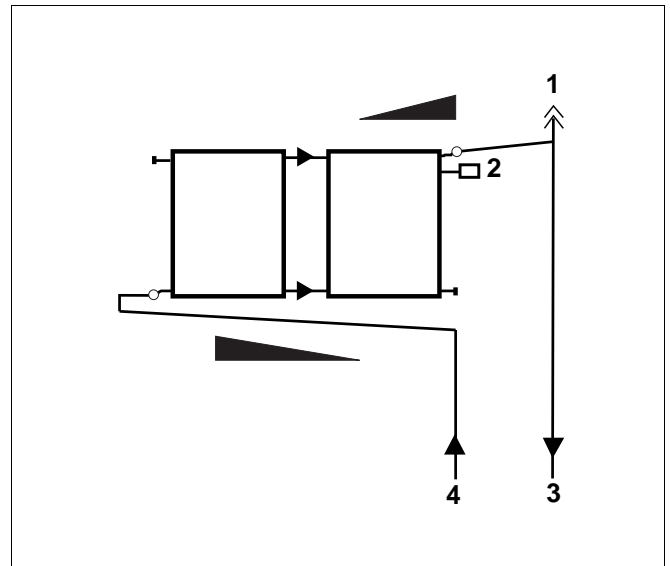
Schemadarstellung (Kollektoranschlüsse)
